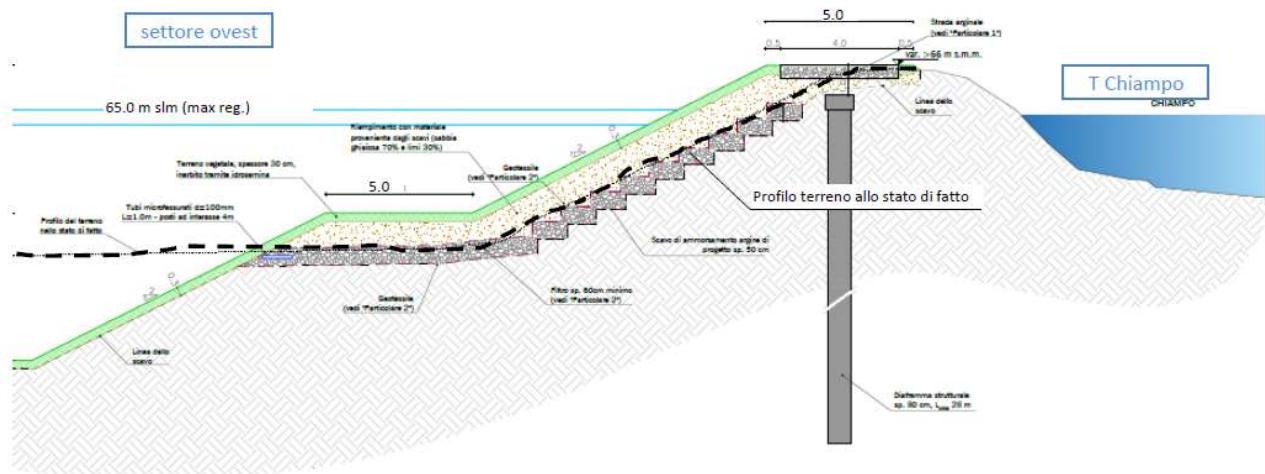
Sezione tipo dell’argine sinistro del fiume Chiampo nel tratto con diaframma strutturale.
